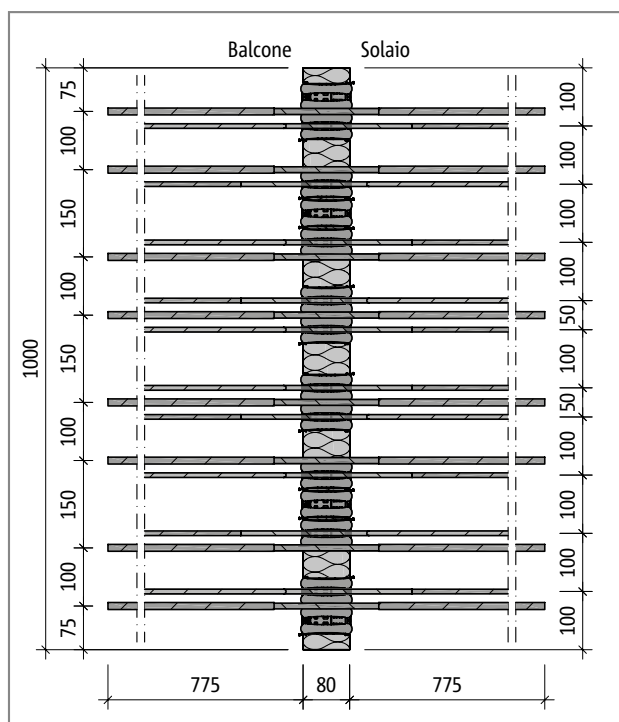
Schöck Isokorb® tipo K70M-VV: pianta del prodotto
